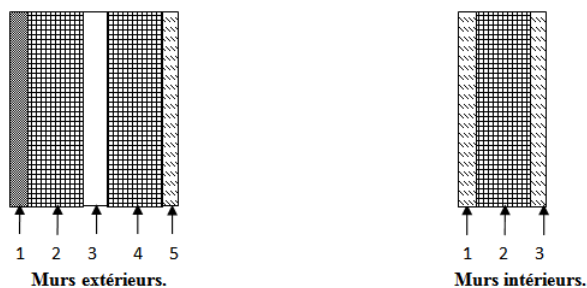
Coupe transversale sur les murs extérieurs et intérieurs
